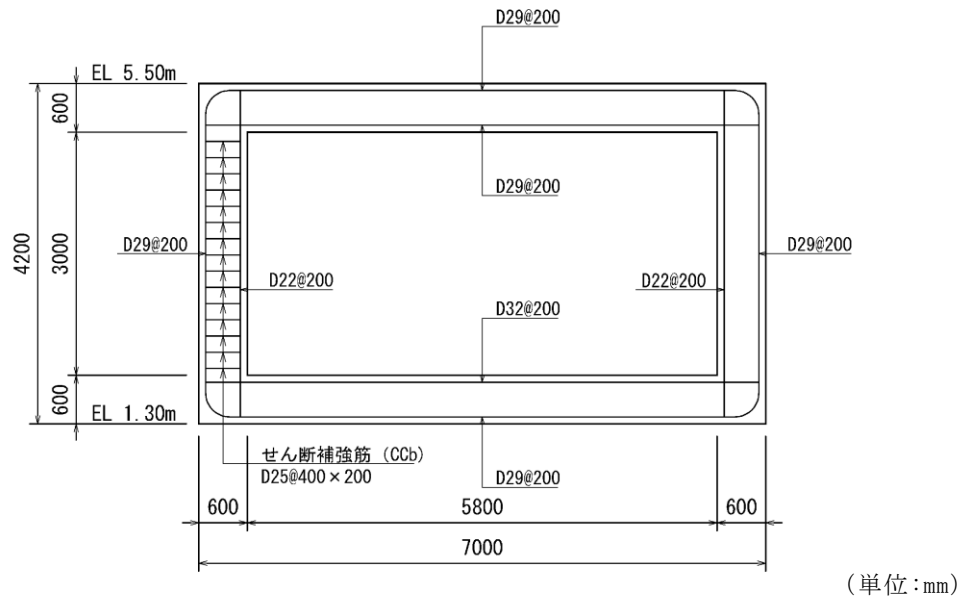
屋外配管ダクト (タービン建物～放水槽) 概略配筋図 (A-A 断面)
